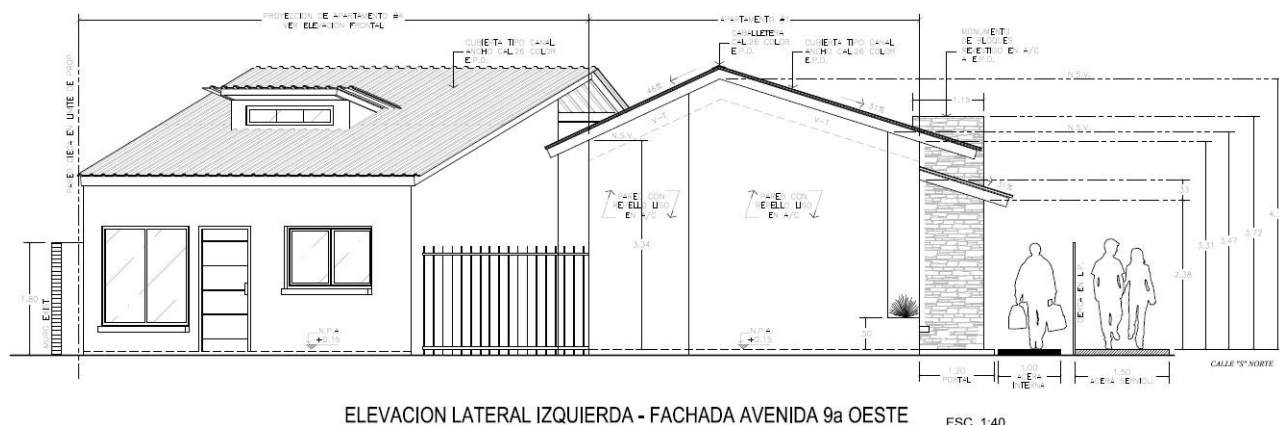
Elevación Lateral – Fachada hacia Avenida 9ª Oeste
